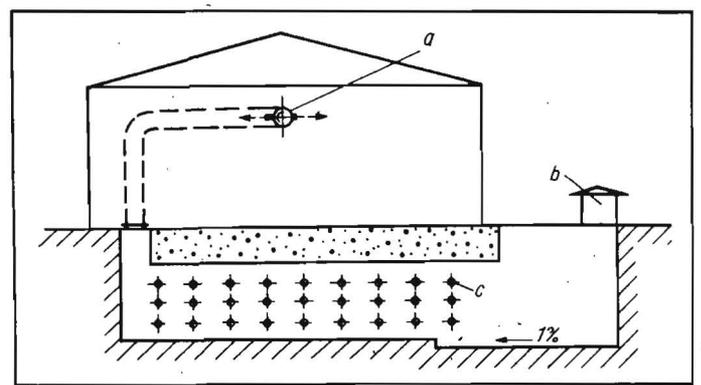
Prinzipskizze eines Putenstalles (Stallquerschnitt) mit Erdreich-Wärmeübertrager unter dem Stallboden; a Zuluftleitung, b Außenlufteinlaß, c Wärmeübertragerrohre in drei Ebenen
